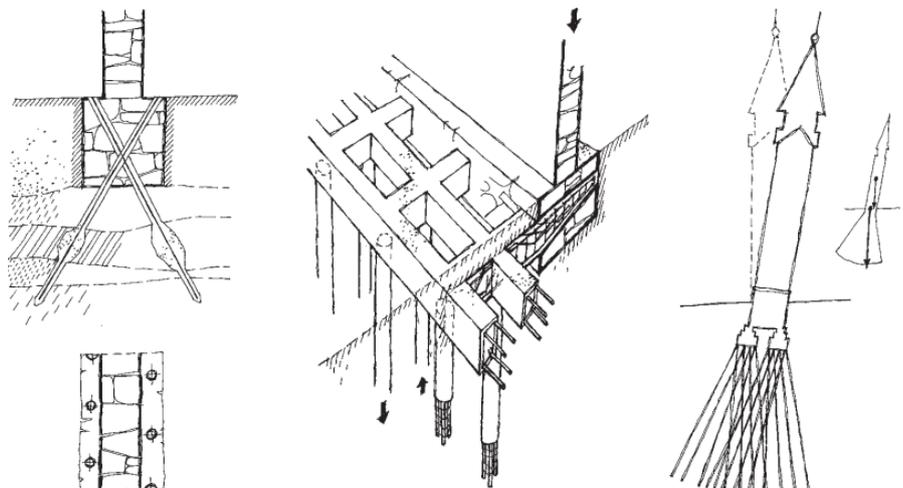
Exemple de confortement de fondations existantes par micropieux, détails de l'arrangement des pieux sous les nouvelles barrettes de fondation.
